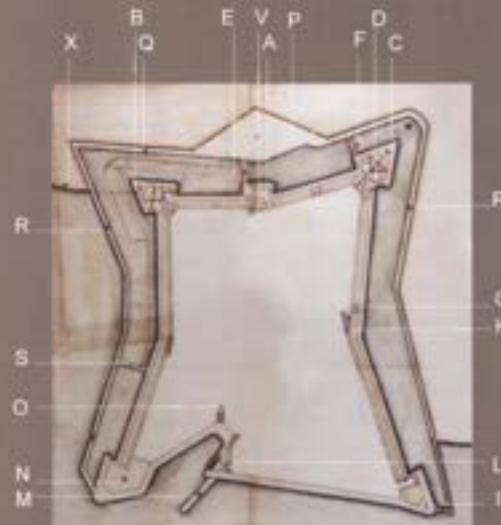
Planta de Mazagão de 1611 (parcial)
